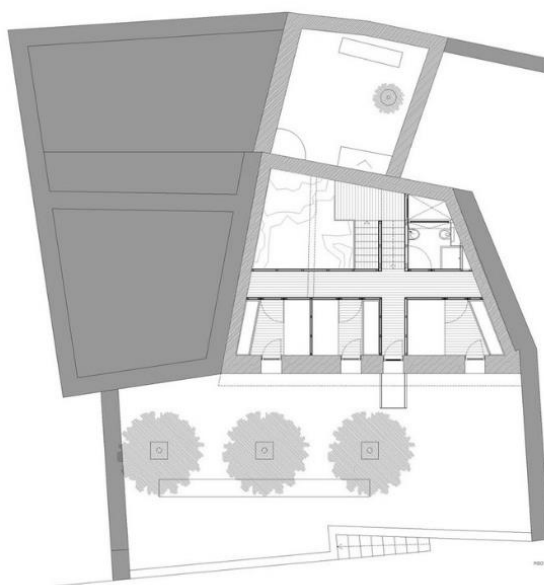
Planta do piso da mezzanine, Casa de Gondramaz
